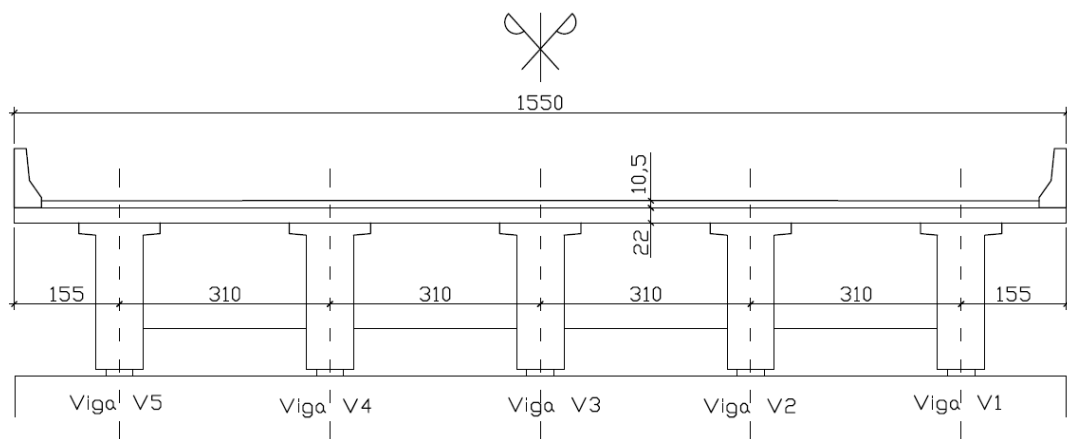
Seção típica do apoio, S1 e S11, da planta de fôrma da ponte rodoviária
